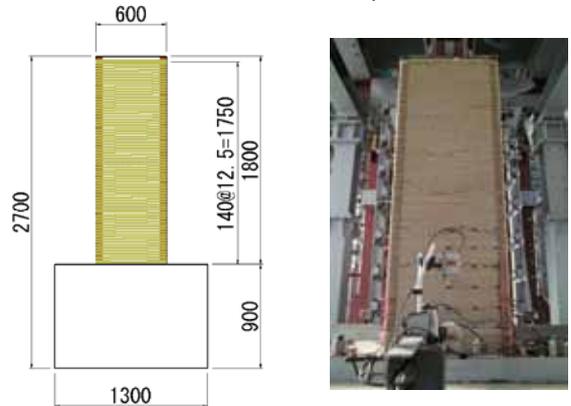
供試体 No.2 補強概要および写真(巻付け間隔 12.5mm)
